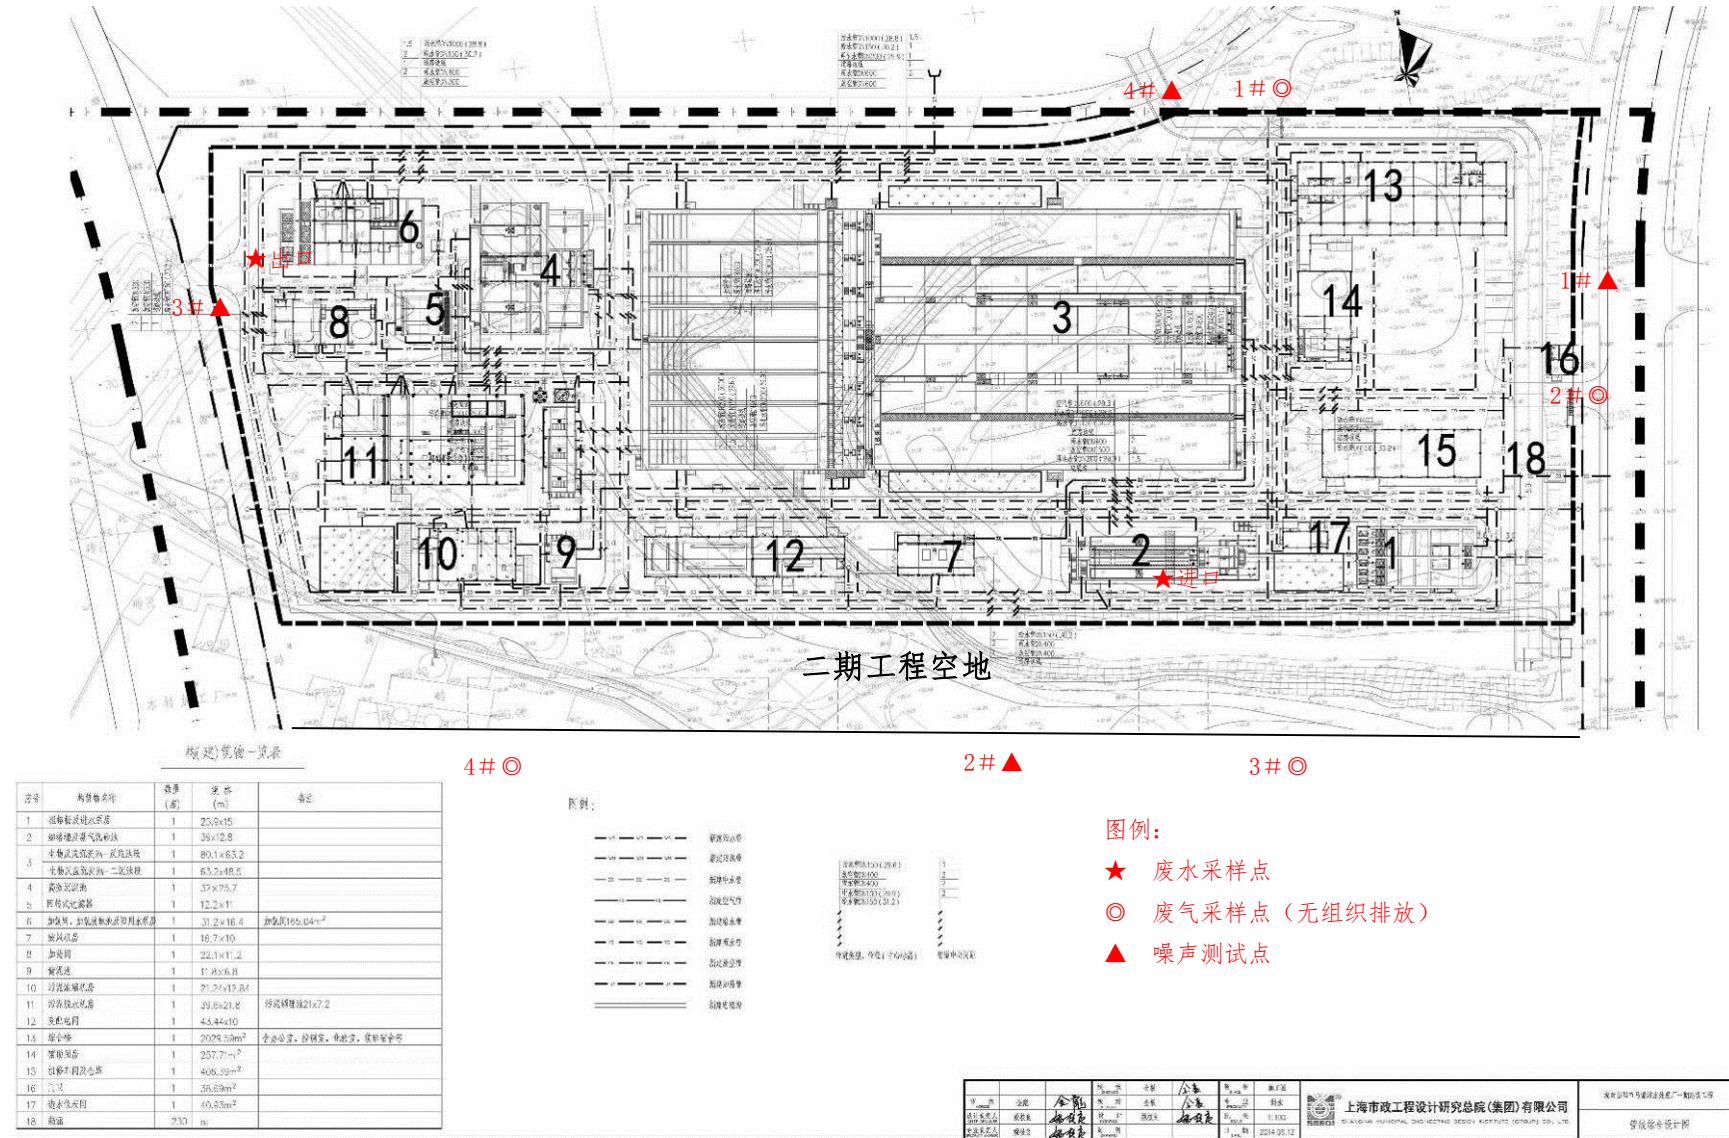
马壕污水处理厂一期工程厂区平面布置及监测点位布设示意图
